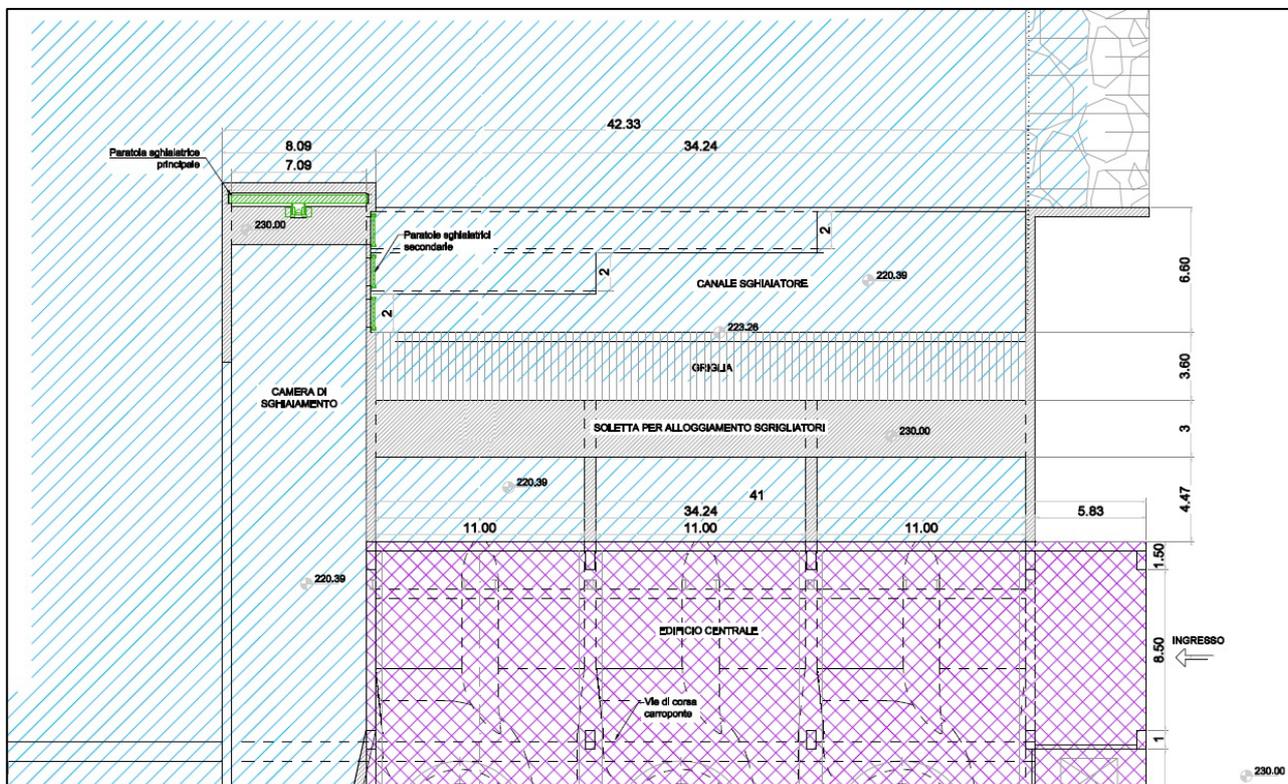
PLANIMETRIA OPERE (DETTAGLIO SISTEMA DI SGHIAIAMENTO)
